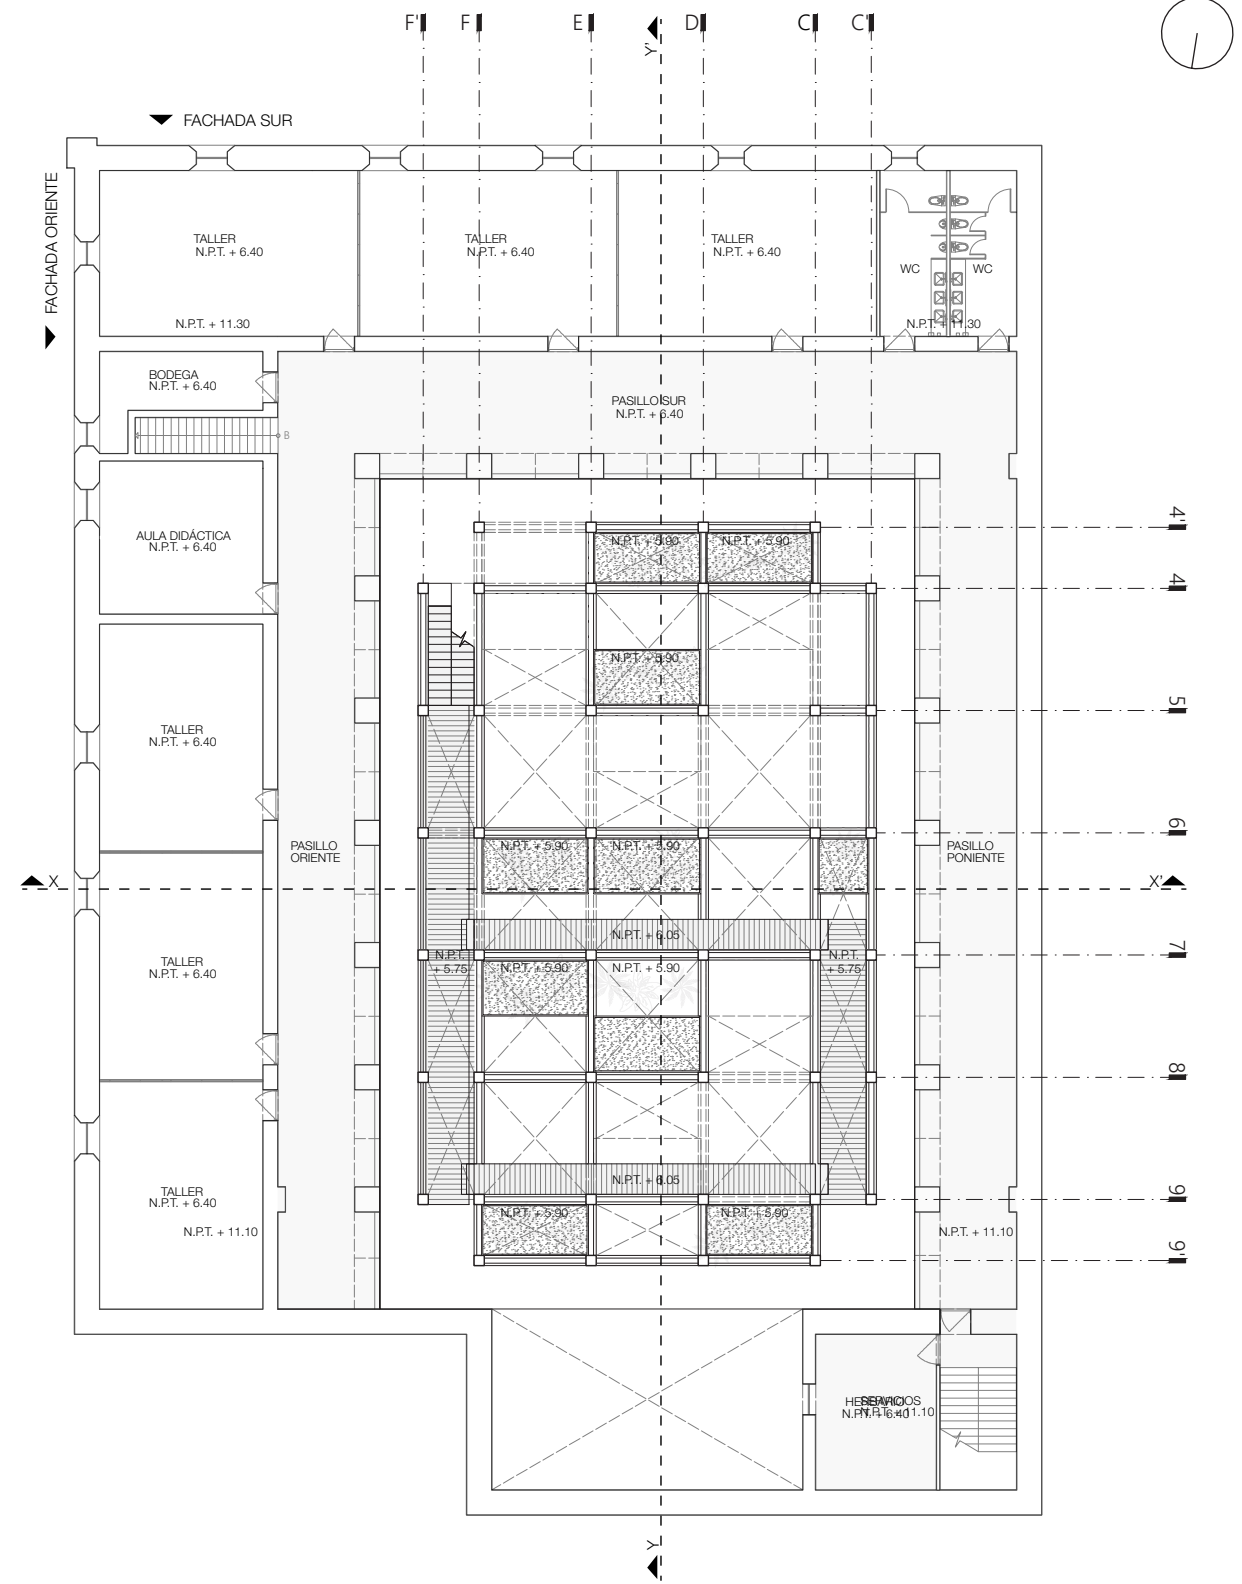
Planta arquitectónica nivel +5.90m. Fuente: Elaboración propia.
